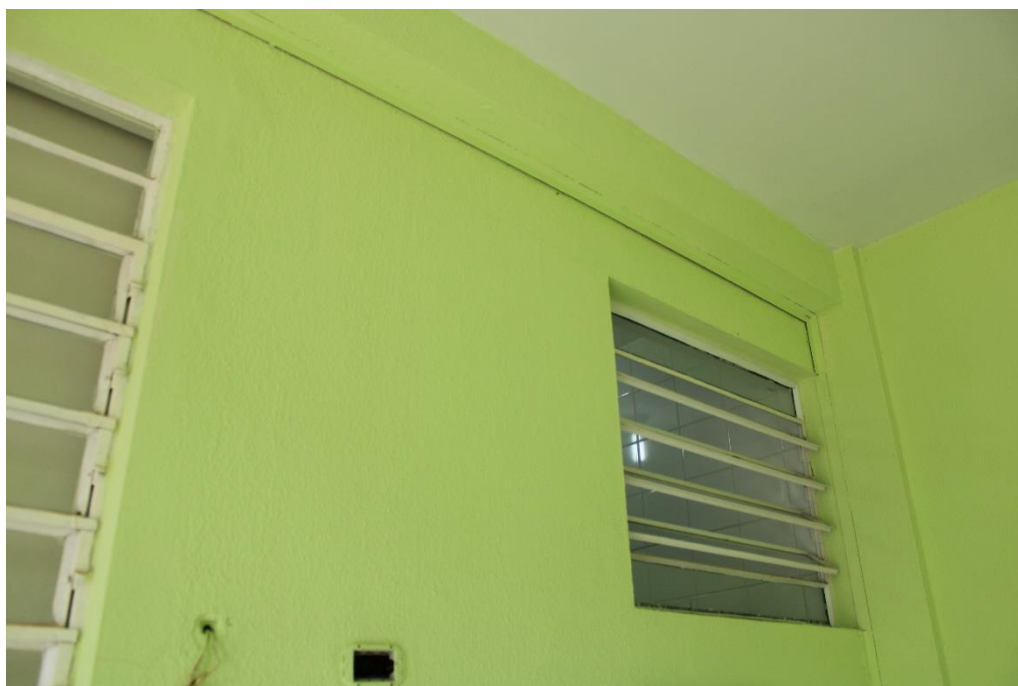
Em detalhe a Foto 133, destacando fissura horizontal no vértice superior de janela.
